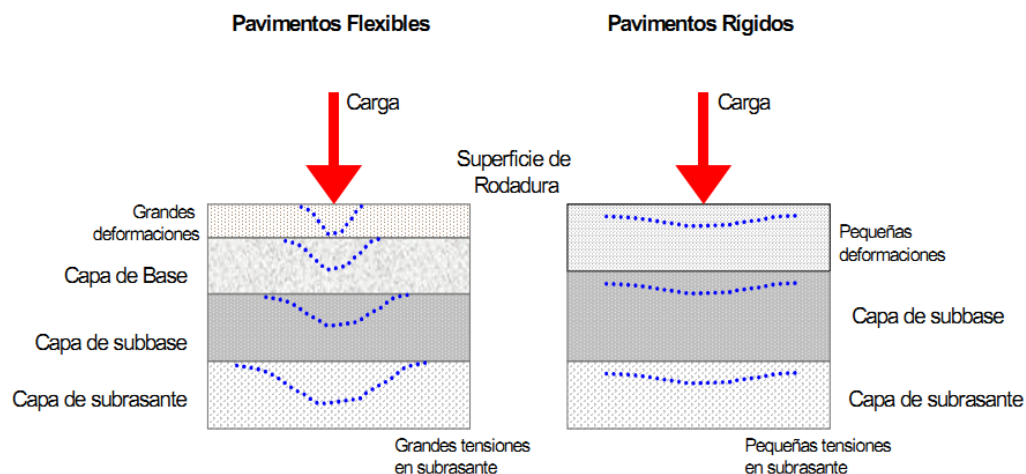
1 - Esquema del comportamiento del pavimento flexible y rígido
